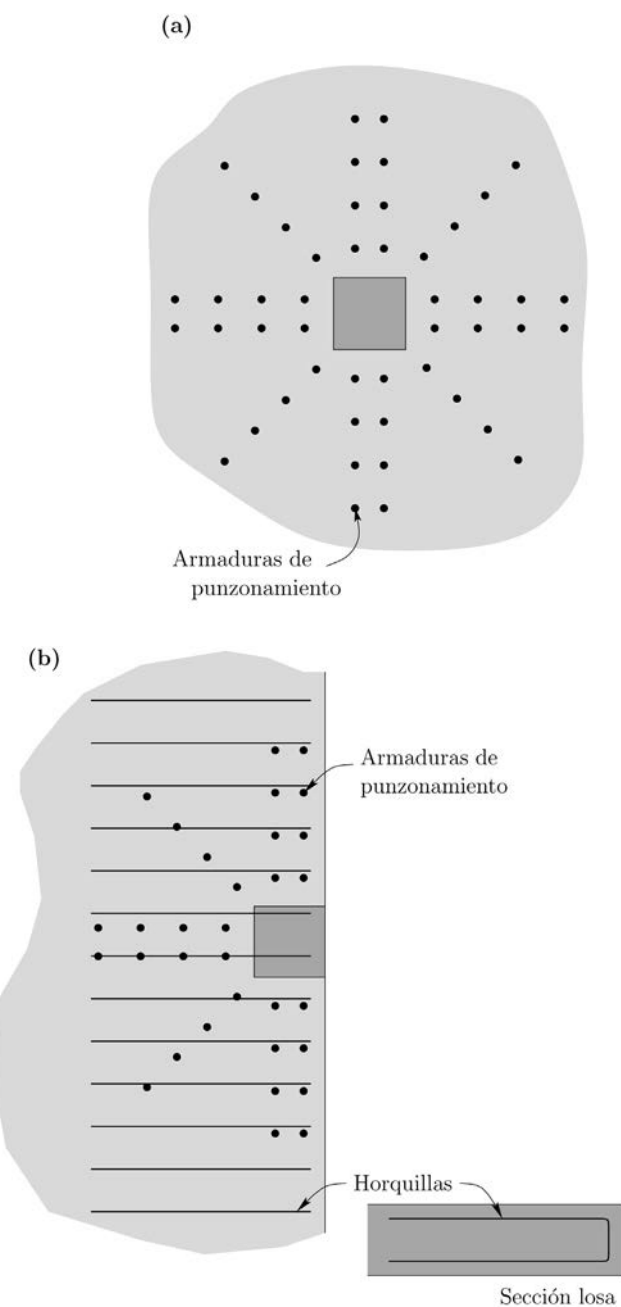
Armaduras transversales: (a) columna central (C3); columna de borde (C2).
